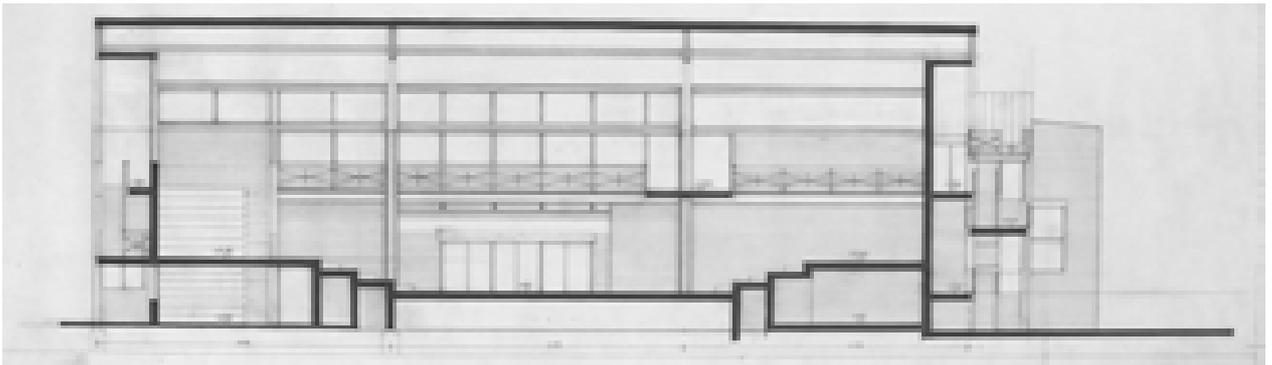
Sezione DD –08/12/1981 (AABS-1996.618)
